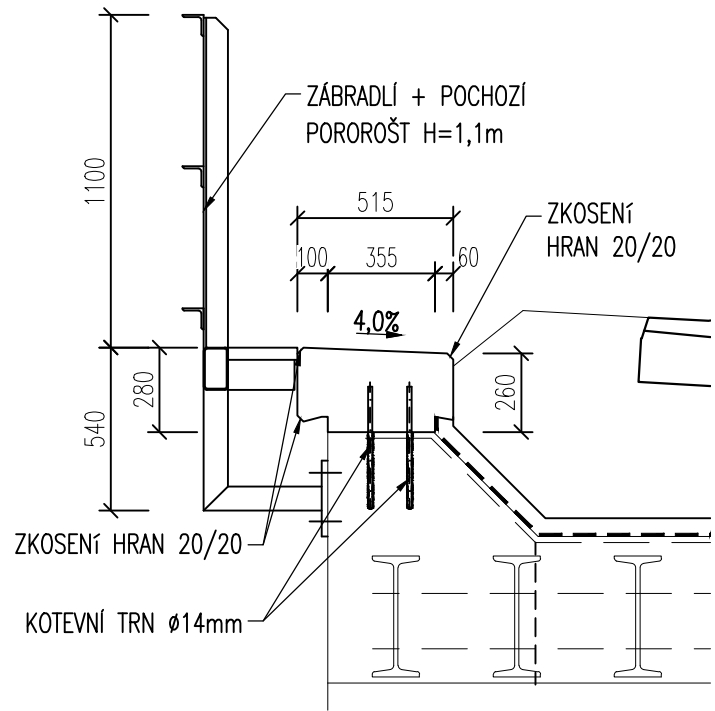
DETAIL SMRŠŤOVACÍCH SPÁR ŘÍMS
